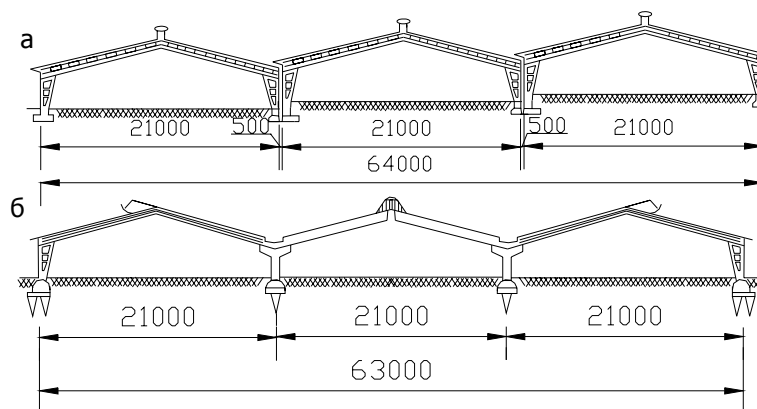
Блоковані і багатопрольотні будинки з каркасом із збірних залізобетонних рам: а) на майданчику із значним нахилом; б) на рівному майданчику
